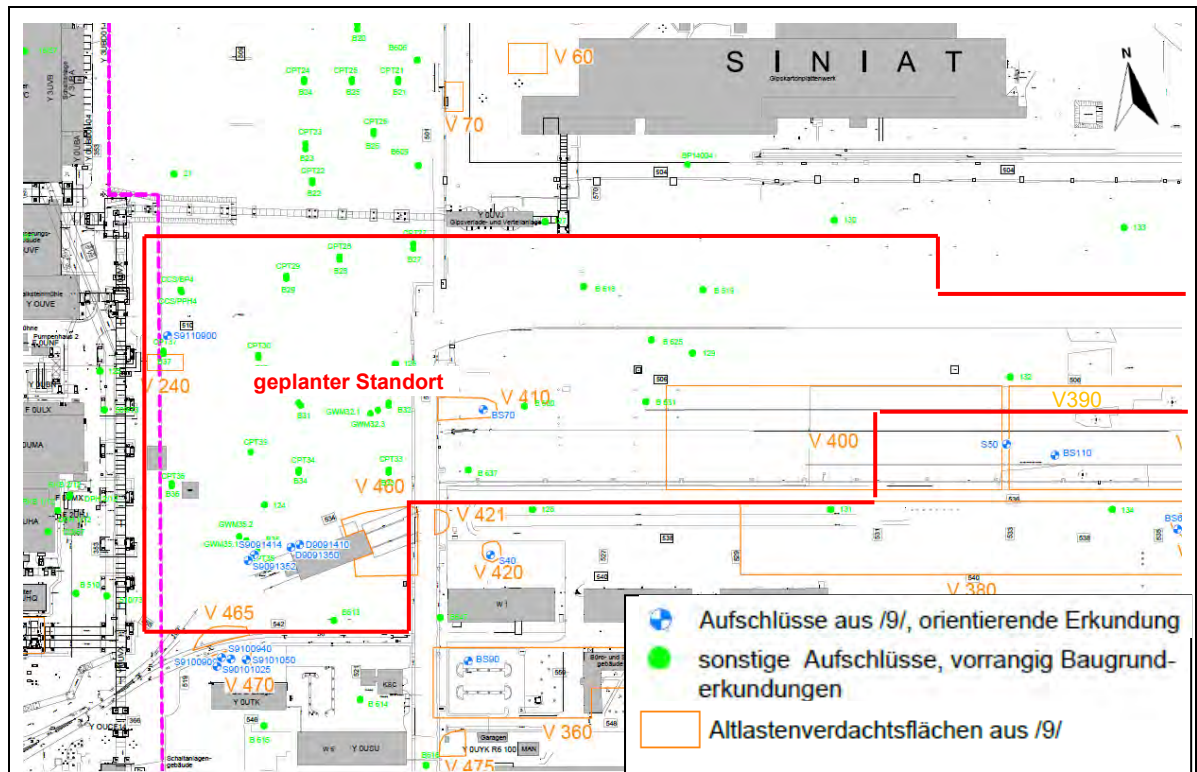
Lageplan mit Altlastenverdachtsflächen und Bohrpunkten Boden und Kennzeichnung der Standortfläche /7/
